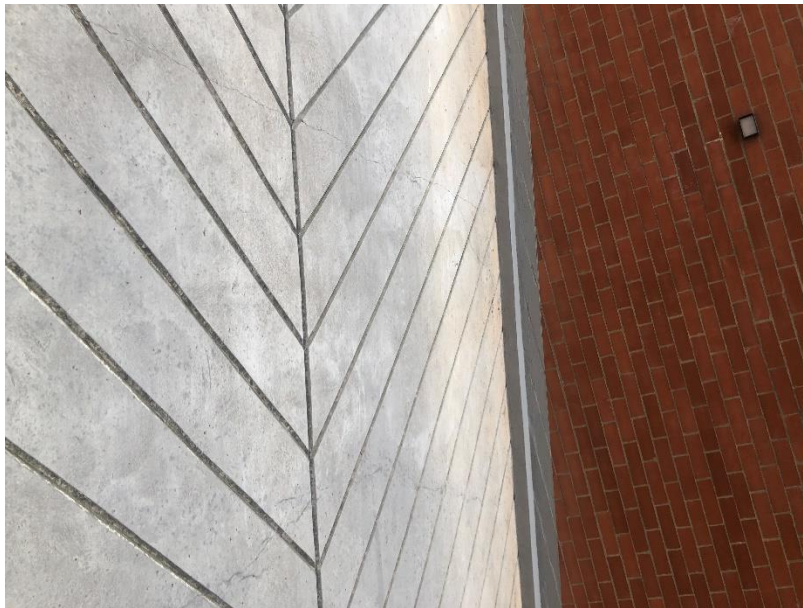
Fisuras en general en toda la rampa de acceso a sótano
